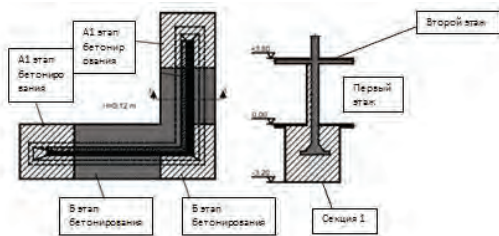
Выемка грунта под фундаментом как часть процесса укрепления
